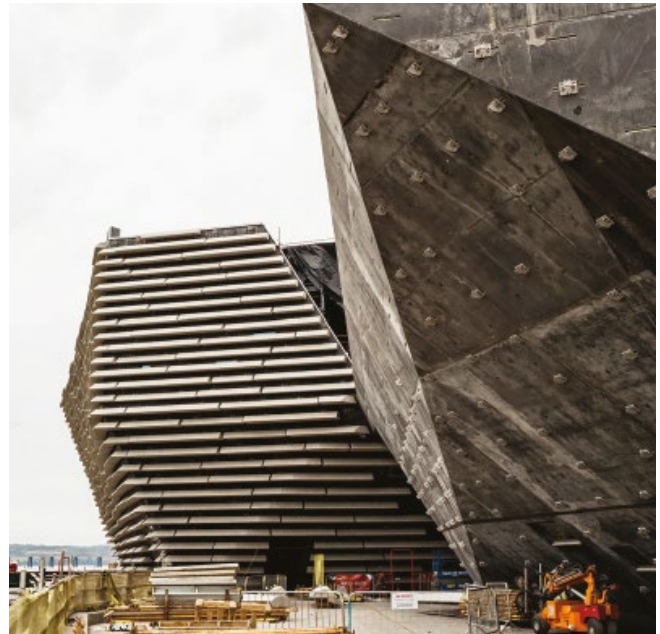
Paredes de fachada hechas en hormigón oscuro y liso
